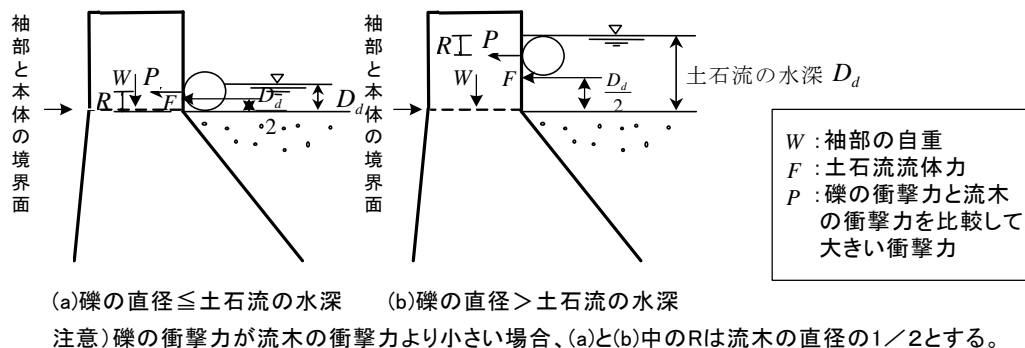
袖部と本体の境界面及び設計外力とその作用点
